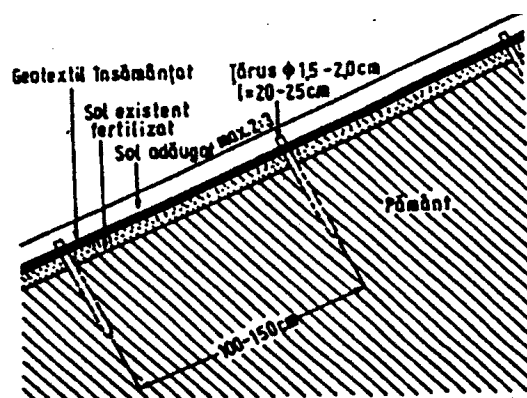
Schema protecției antierozionale a versanților cu geotextil însămânțat
